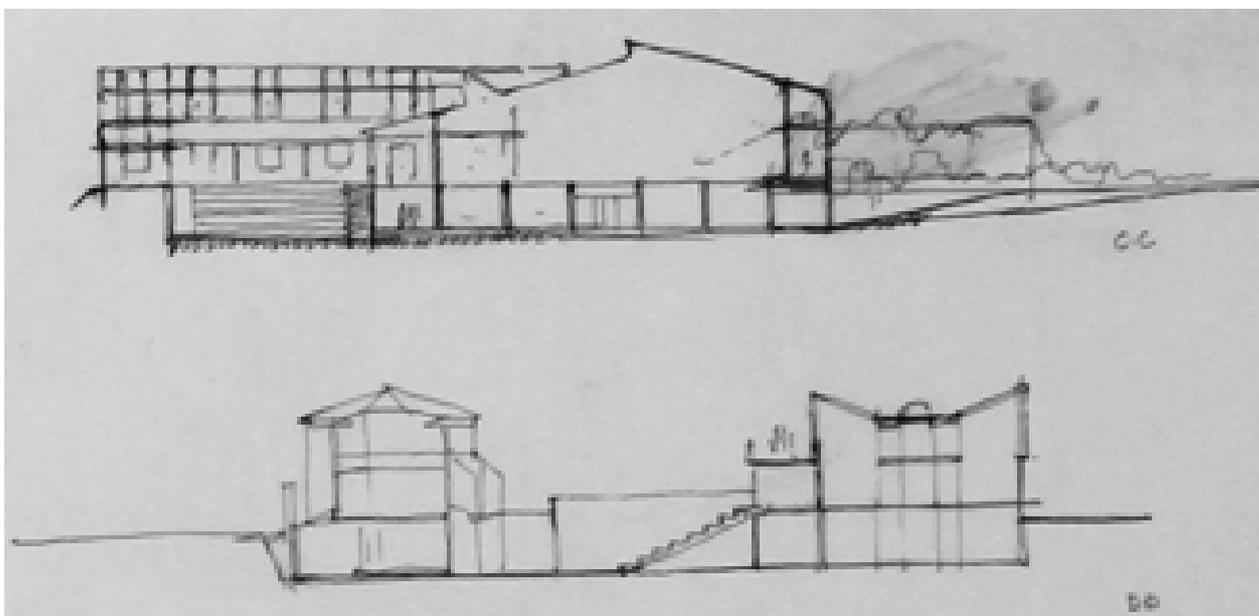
Sezioni CC-DD, stato futuro – 19/11/1993 (AABS-64_253)
